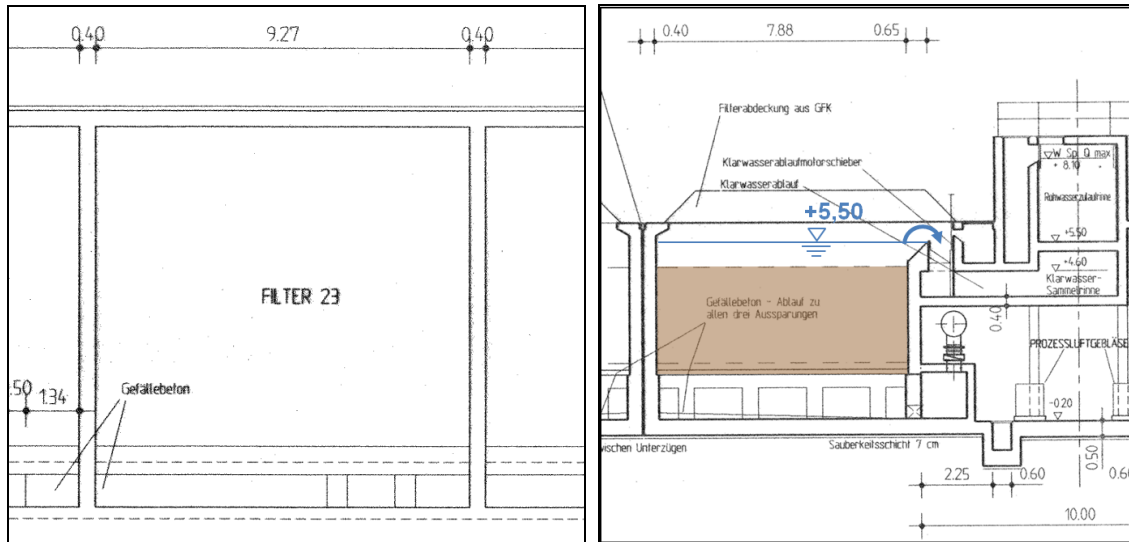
Schematischer Grundriss (links) und Längsschnitt (rechts) eines Filters zur biologischen Nachbehandlung
